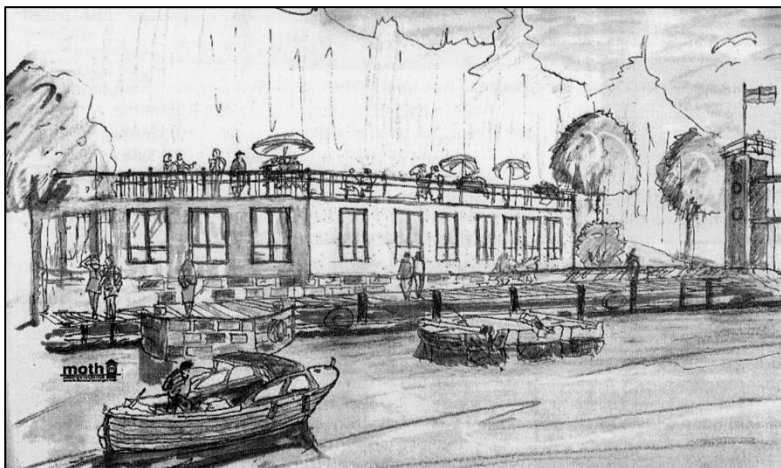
Illustrasjonen viser hovedtrekkene i det planlagte tiltaket. Restaurantbygget med tilhørende bryggeanlegg restaureres. Badehus og stupetårn bygges opp på opprinnelig sted. Det planlegges et nytt servicebygg tilbaketrukket fra sjøen for å sikre moderne restaurantdrift. Der toalettbygget var, tenkes det bygget en liten badstue. I badesesongen skilles badeområde fra båtens manøvreringsareal med bøyer. Illustrasjonen viser også mulige stisystemer. Sentralt her er en sti som forbinder bryggen mot servicebygget og adkomstveien. Denne legges slakt i terrenget, og vil kunne opparbeides med tilnærmet universell tilgjengelighet.
